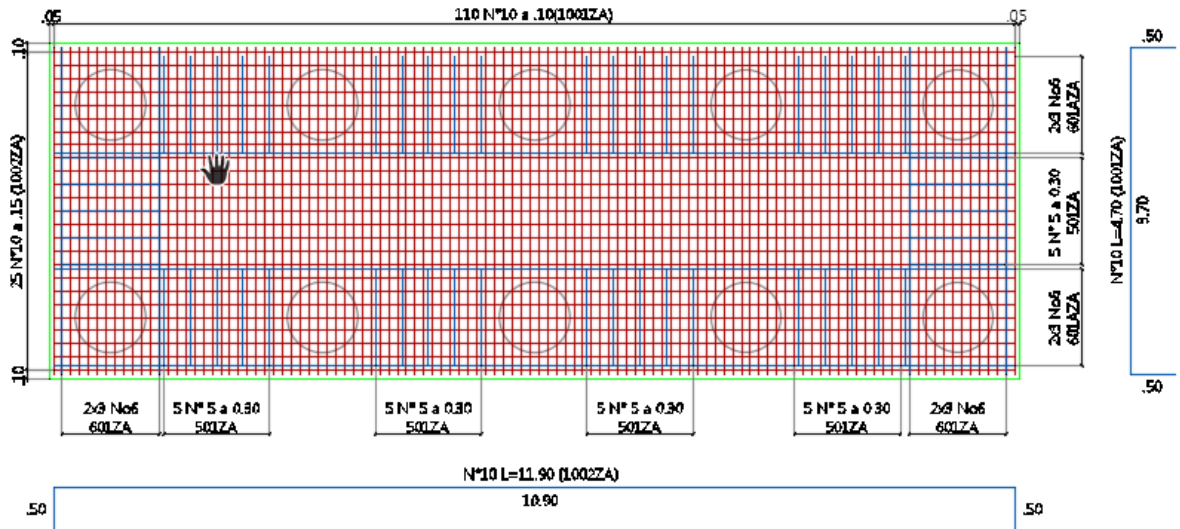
Detalle refuerzo inferior zapata sobre el eje 2 y 3. (Dis Diseñadores)
